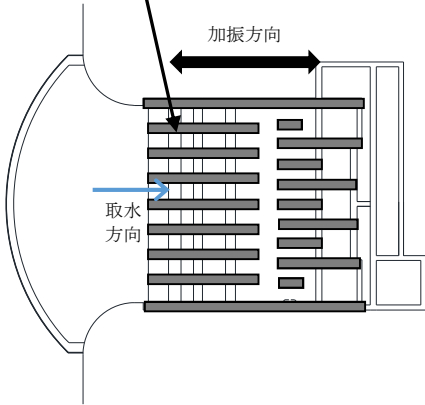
(2) 取水構造物の平面配置図（拡大図）
